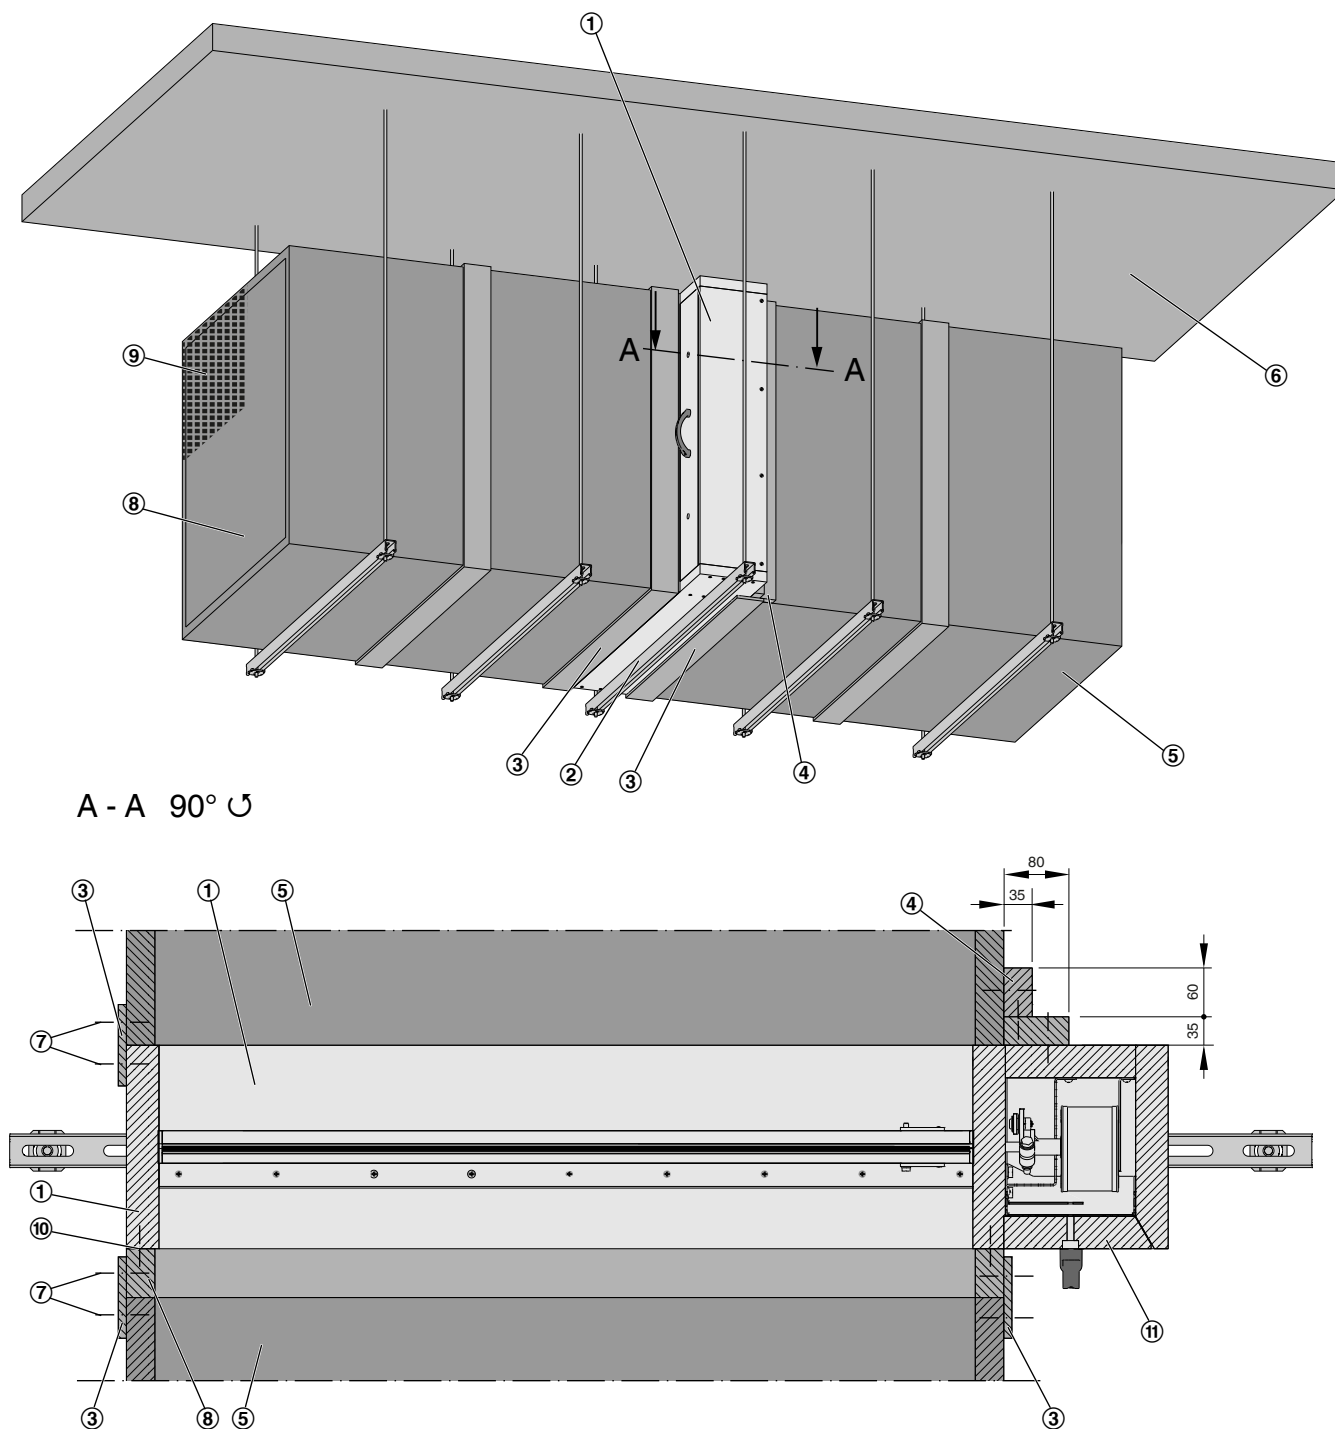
Einbau in einer horizontalen Entrauchungsleitung
